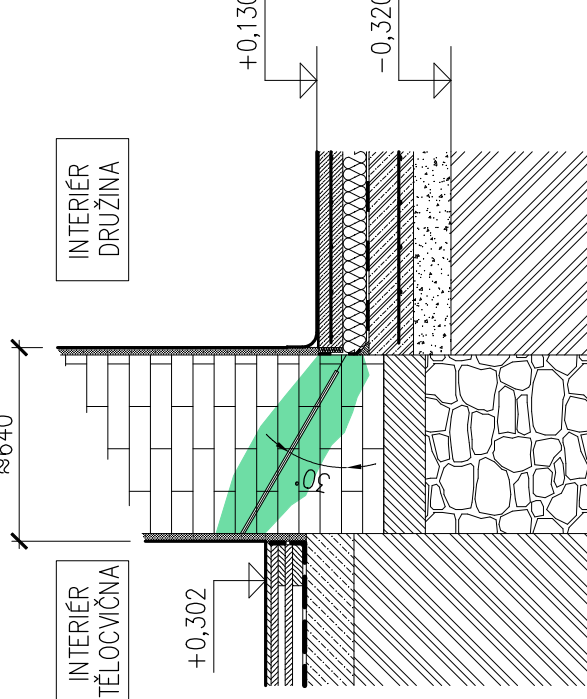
PŘÍČKA MÁ VLASTNÍ ZÁKLAD
